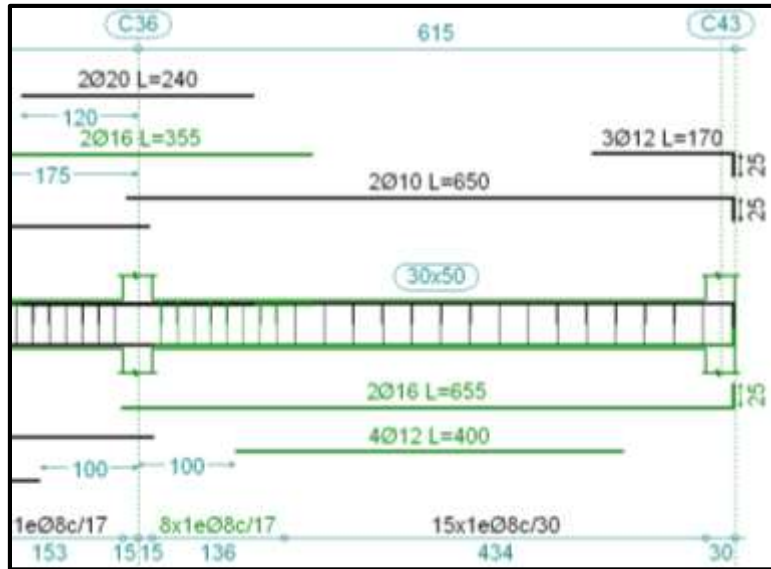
Armado de la viga, entre las columnas C36 – C43 primera losa (Fuente: CYPECAD 2014)
